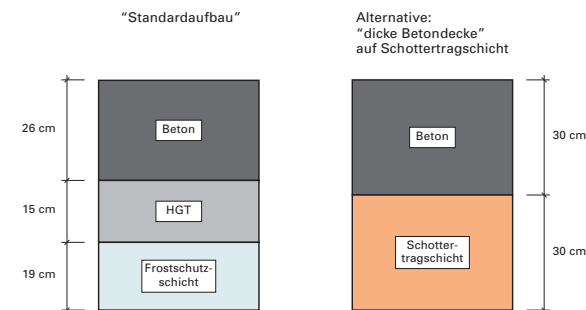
Standardisierte Betonbauweise: Standardaufbau und als Alternative die „dicke Betondecke“ auf Schottertragschicht
